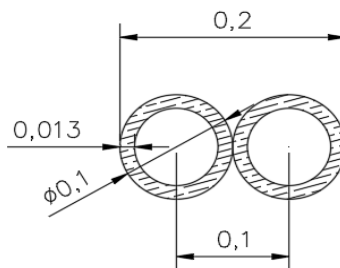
Secciones típicas de refuerzo para diagonales entre arco 3 y 4
